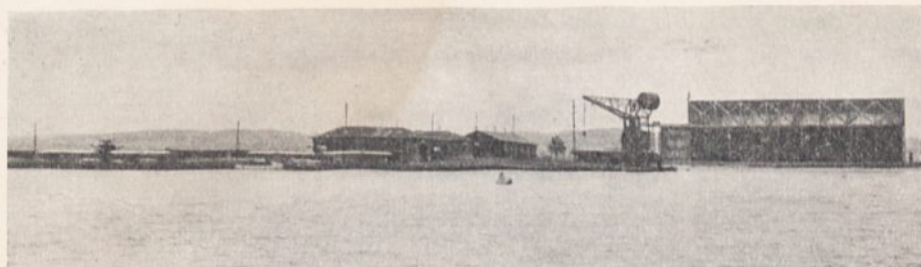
Hafenanlage mit Halle und Kran. — Zwei Wale in Stichkanälen.
